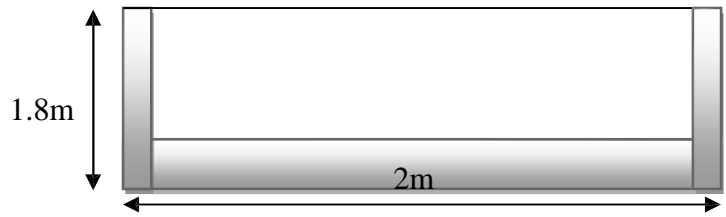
Schéma de Ferrailage de la dalle sur 4 appuis.
